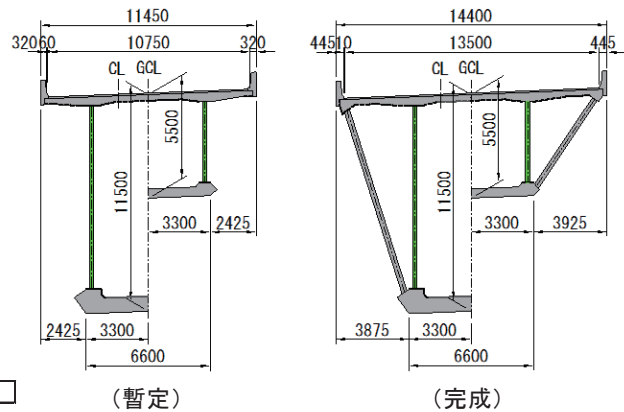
主桁断面図 (波形鋼板ウェブ最大桁高部)
